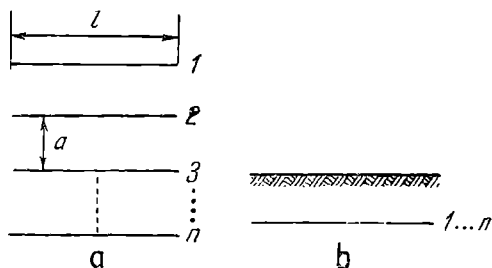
Poziția electrozilor orizontali: a — în plan orizontal; b — în plan vertical.
